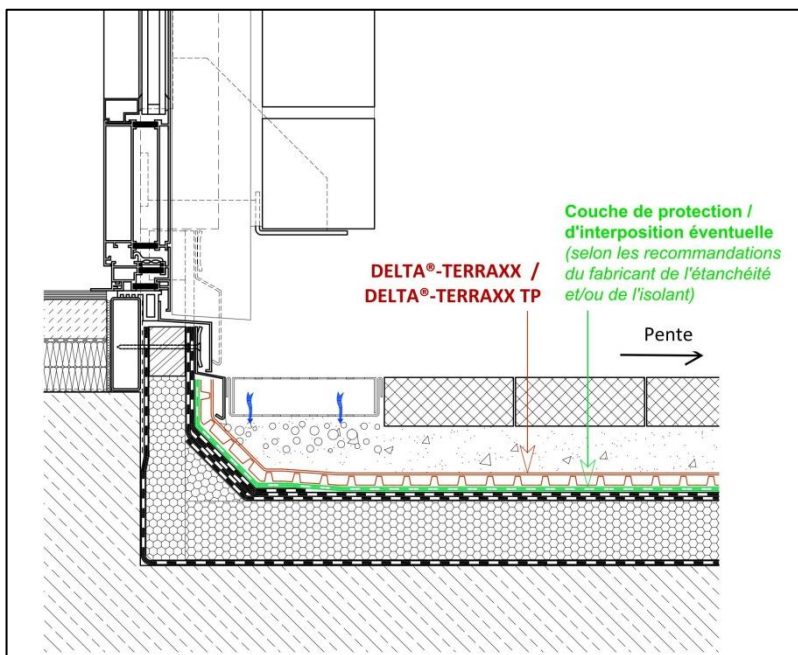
détail de seuil de porte avec accès de plain-pied avec membrane d'étanchéité bitumineuse + DELTA®-TERRAXX / DELTA®-TERRAXX TP (protection lourde avec dalles ou pavés)
